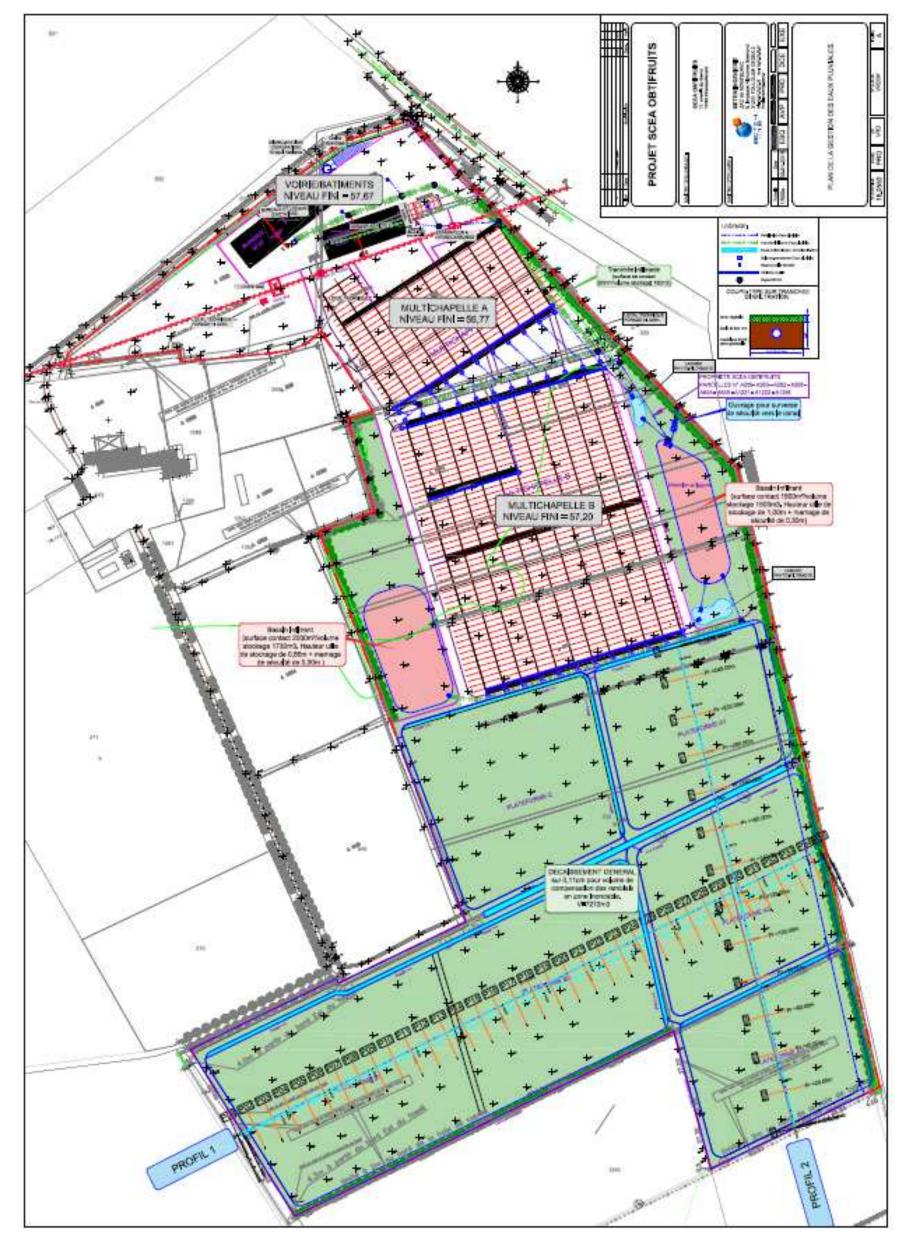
Plan du projet et ouvrages de gestion des eaux pluviales (source : Plan de masse, BETEM, 30/01/2019)
